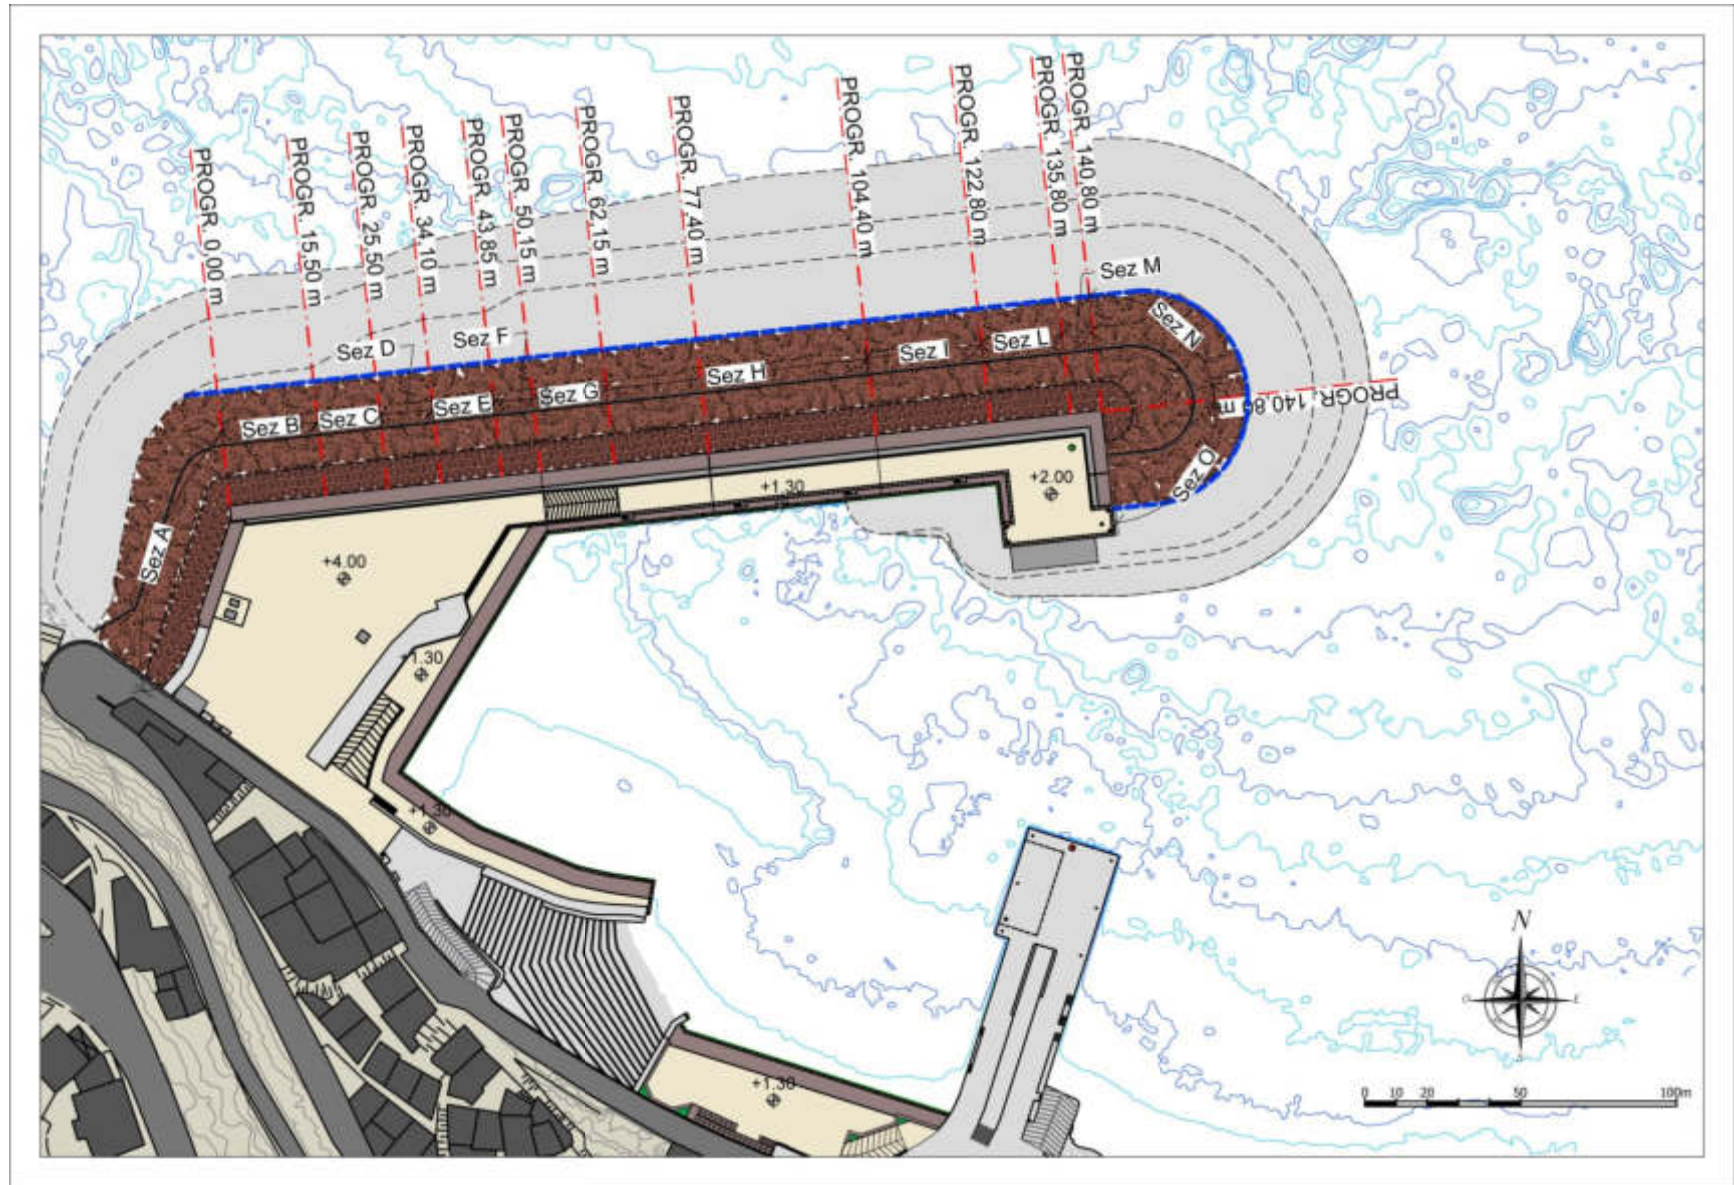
Planimetria con indicazione delle sezioni tipo della diga foranea
